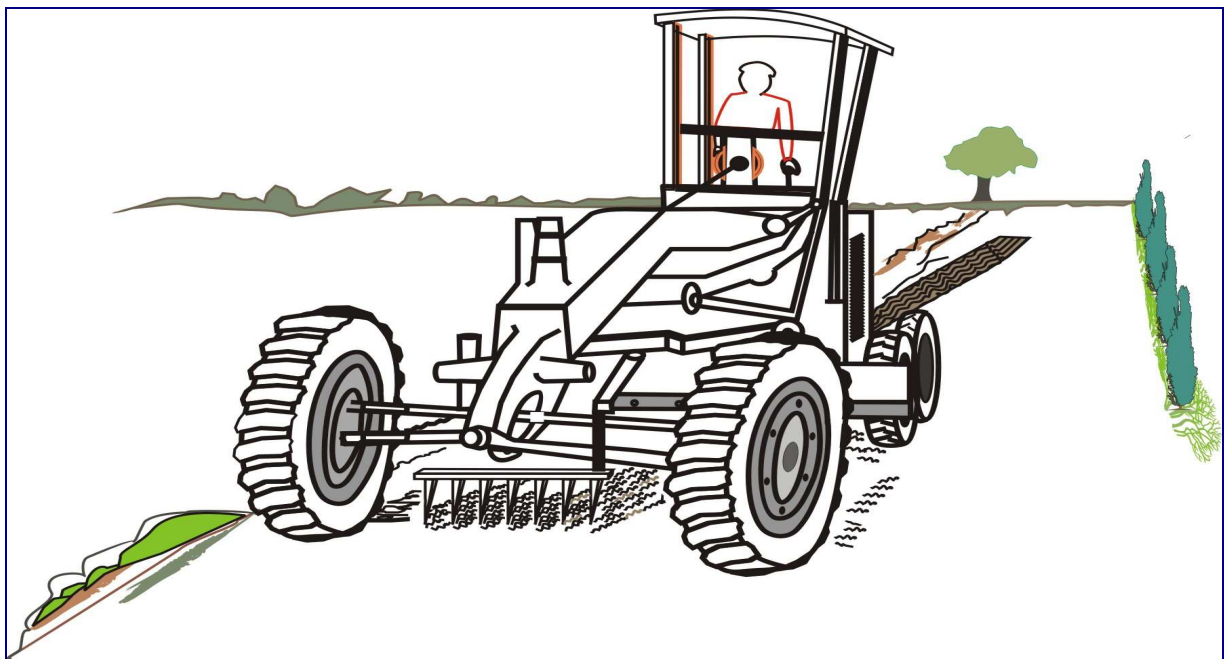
Escarificação (“arranhamento”) do leito.
